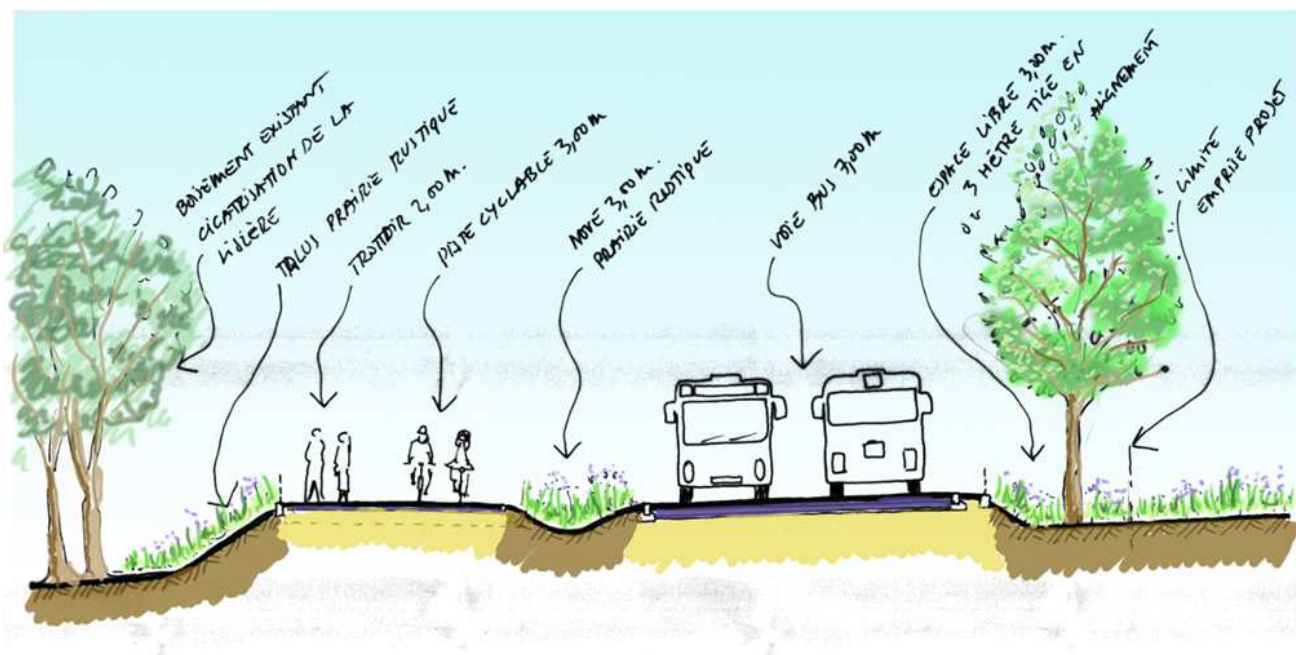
Coupe transversale de la voirie illustrée au niveau du boisement (dossier PRO)
